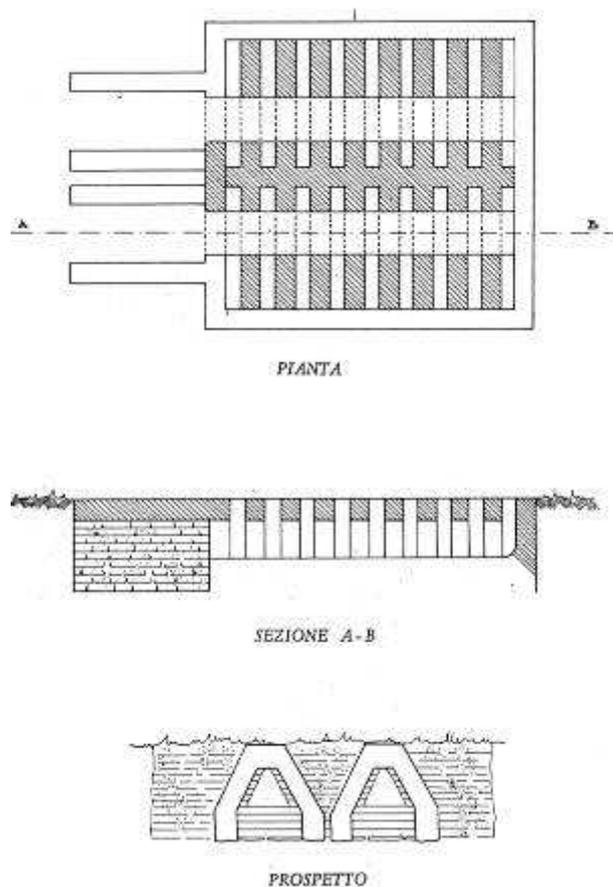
Locri. Pianta, sezione e prospetto di una fornace rettangolare con due prefurni (V sec. a.C.) (CUOMO DI CAPRIO 1985)
